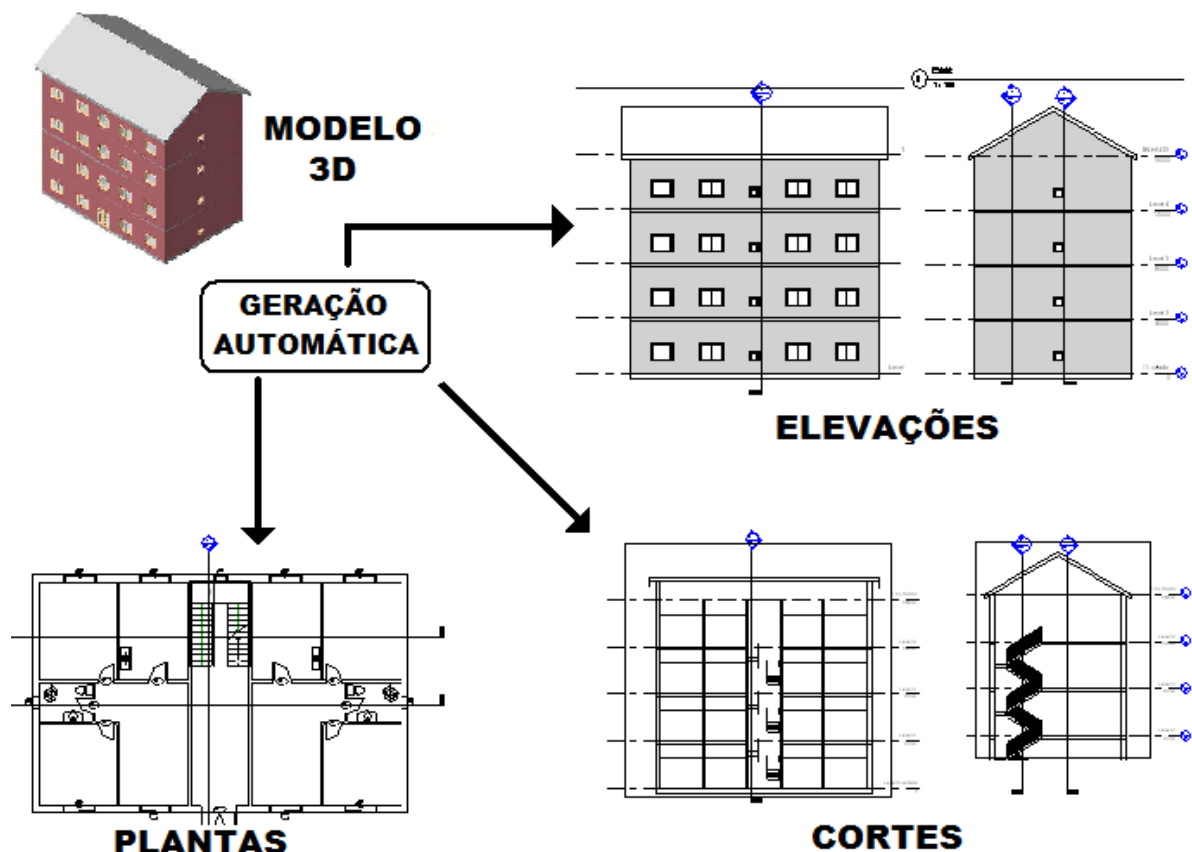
GERAÇÃO DE PLANTAS, CORTES E ELEVAÇÕES
